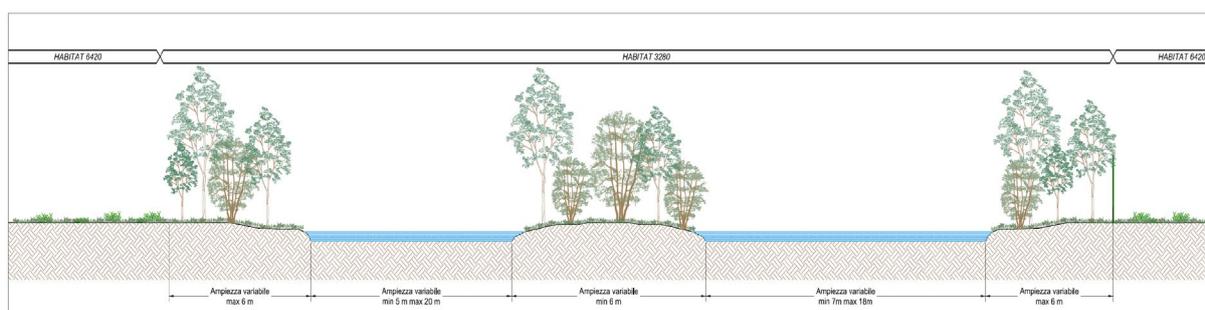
Vista verso Sud da Via Mollaia, estratto da FLR-MPL-PSA-CAP2-004-PA-DG_Mollaia Plan Sez Prog
